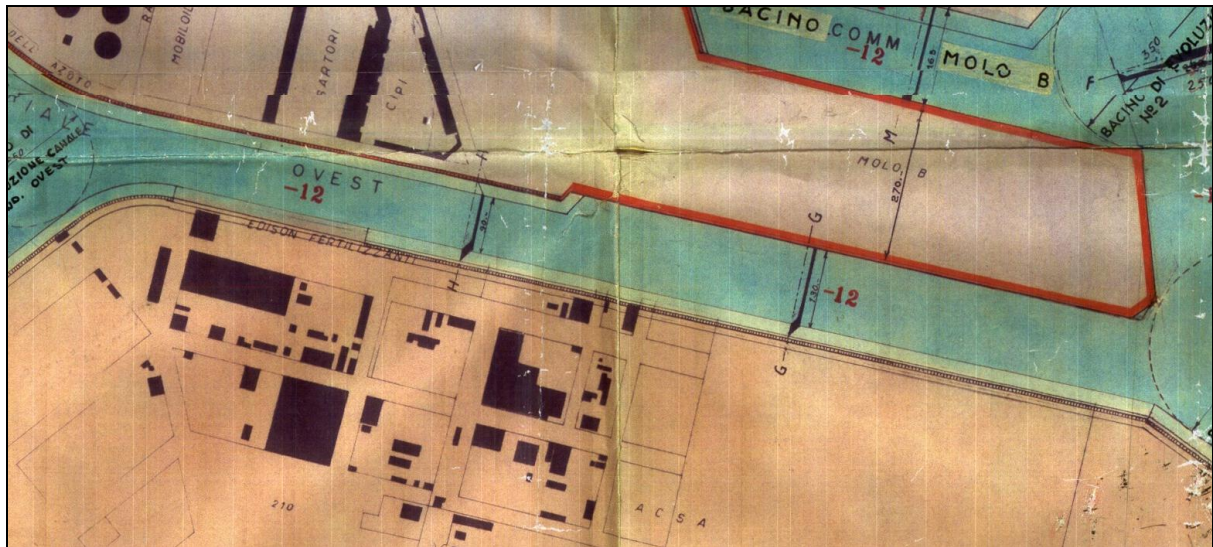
P.R.P. e dimensioni delle cunette di navigazione
